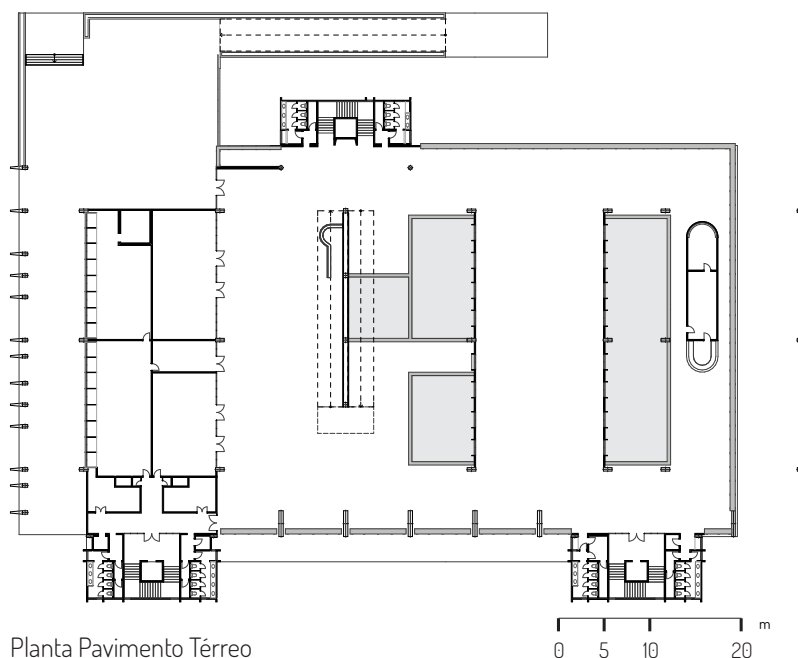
Planta do pavimento térreo em seu estado atual
